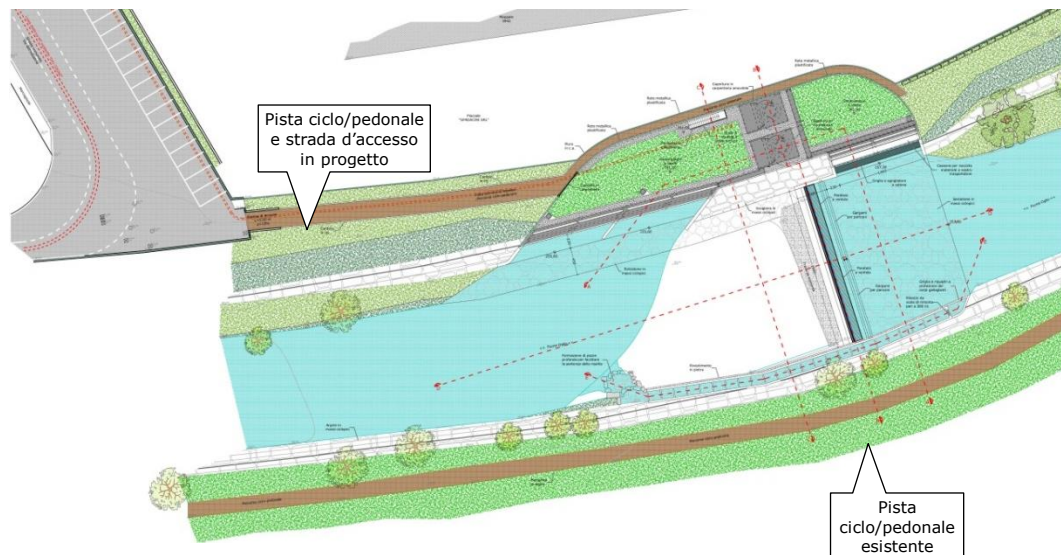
Individuazione viabilità d'accesso su planimetria di progetto
